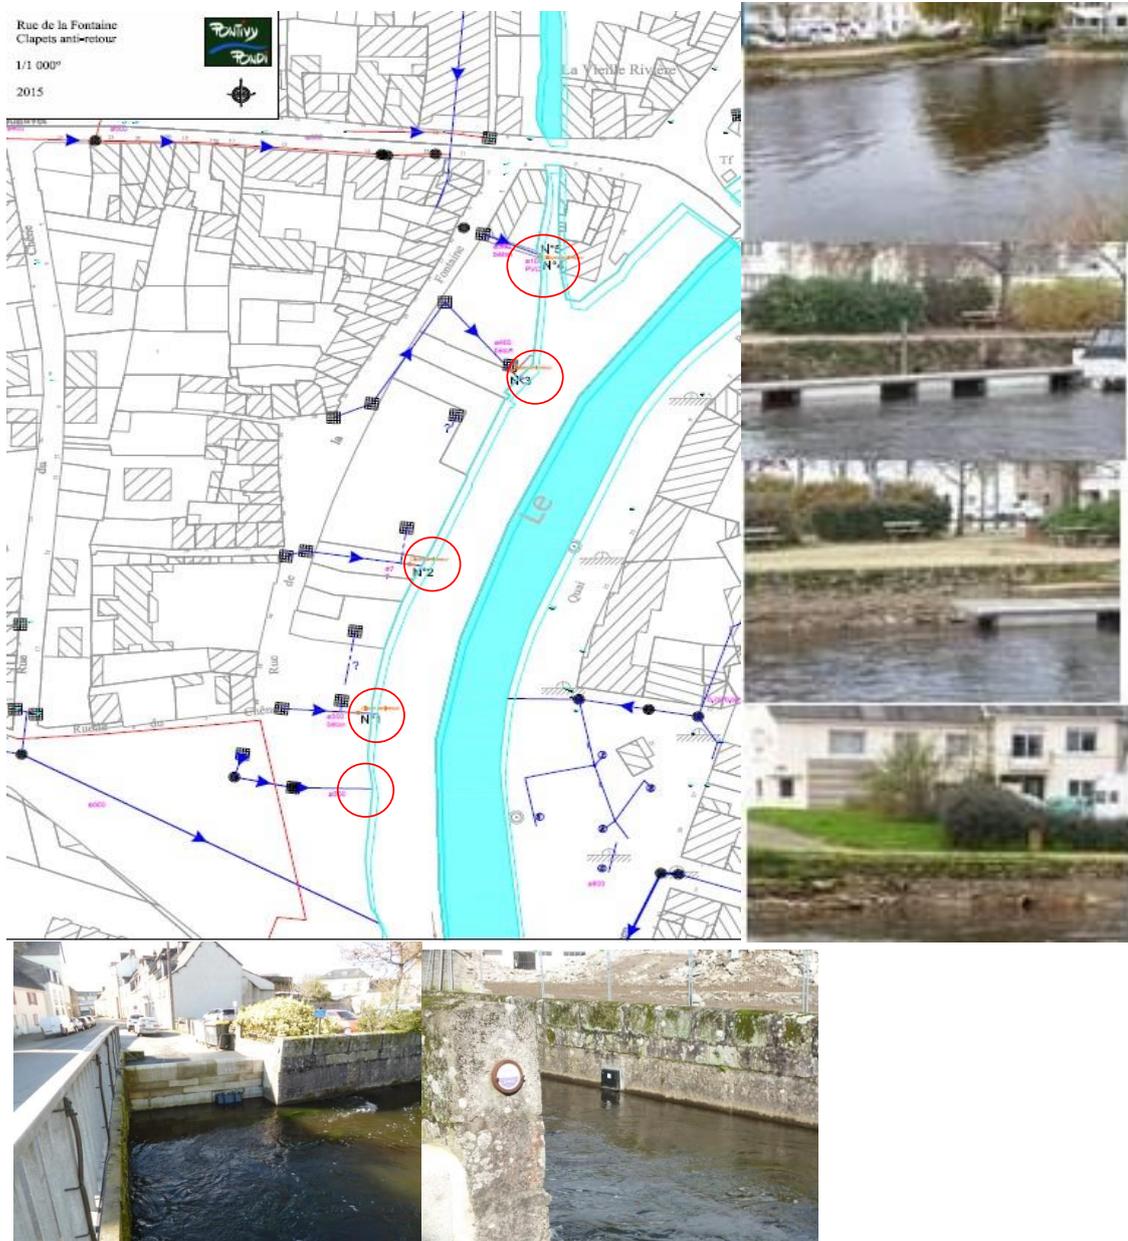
Installation des clapets anti-retour par la ville de Pontivy
